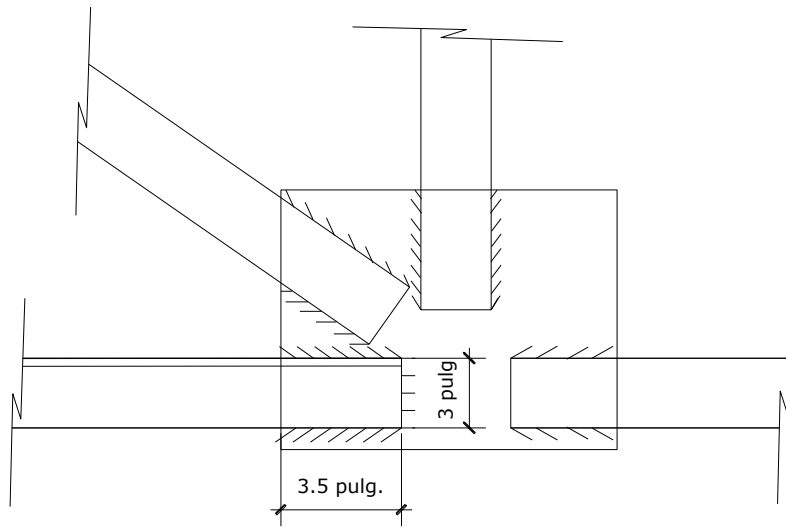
Detalle de conexión soldada en el nudo de la armadura.
